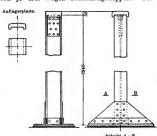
Eisenconstruction einer Tunnelstrecke.
